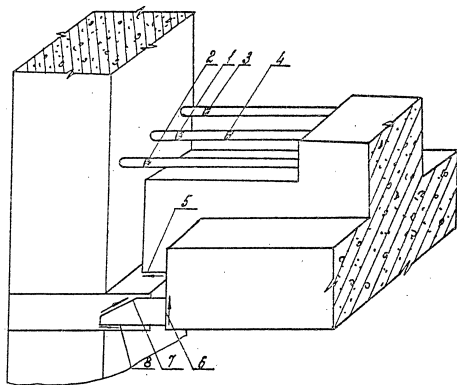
Порядок выполнения сварных соединений в узле сопряжения ригеля с колонной.
